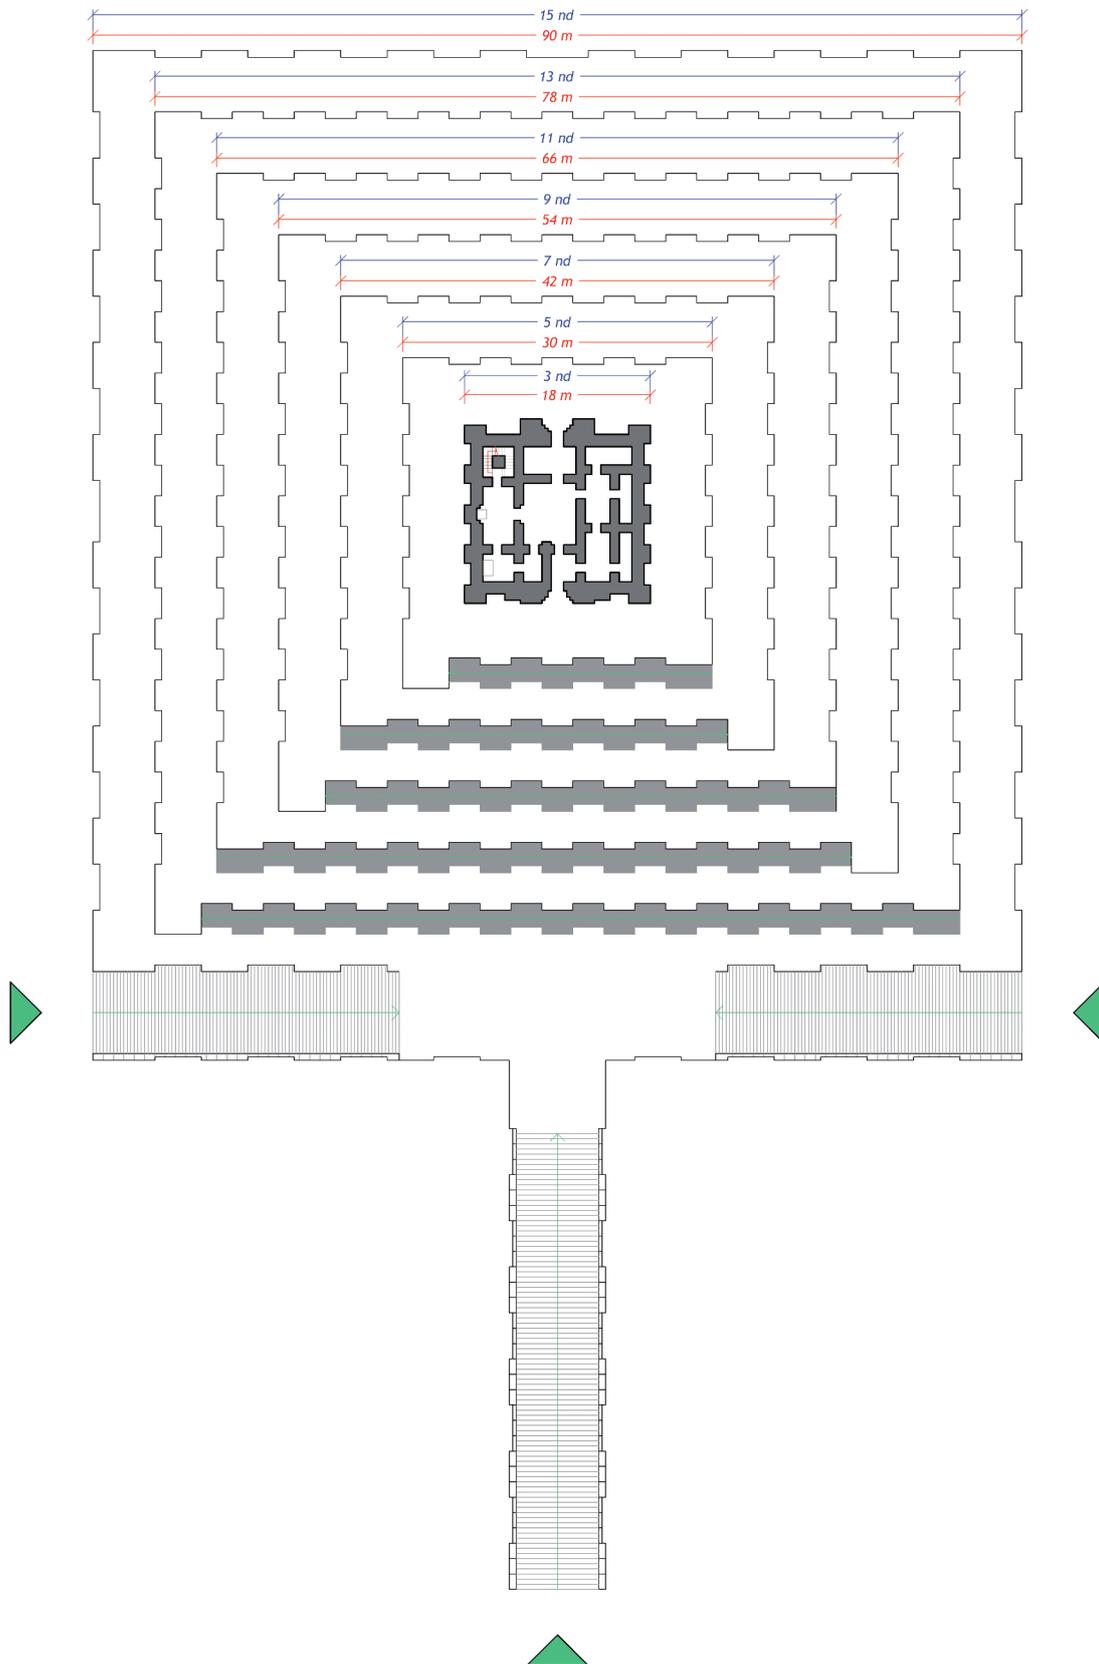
Plan de la ziggurat de Babylone. Hypothèse A : accès en zigzag sur la façade principale (voir fig. 9).
